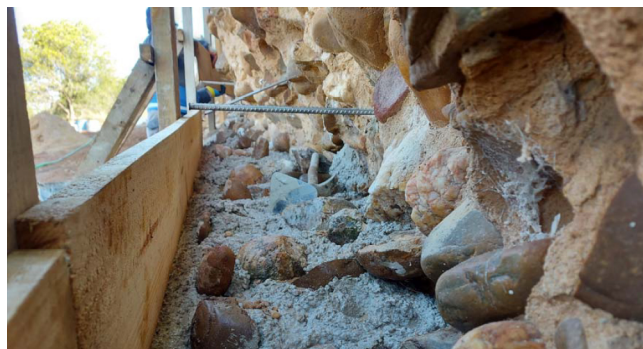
Varillas de acero inoxidable en la base del refuerzo
